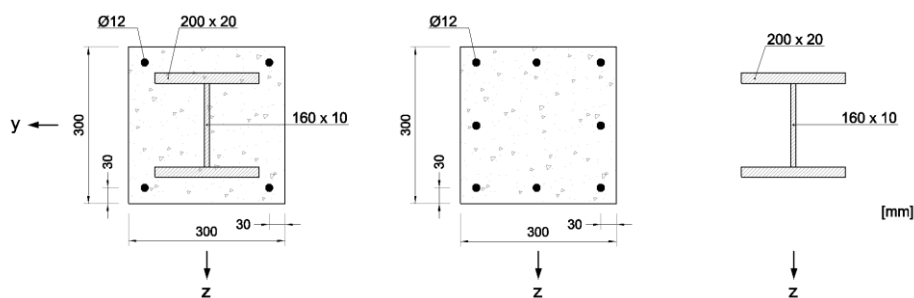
(ESQ. – DRT.) SECÇÃO TRANSVERSAL MISTA, DE BETÃO ARMADO E DE AÇO
